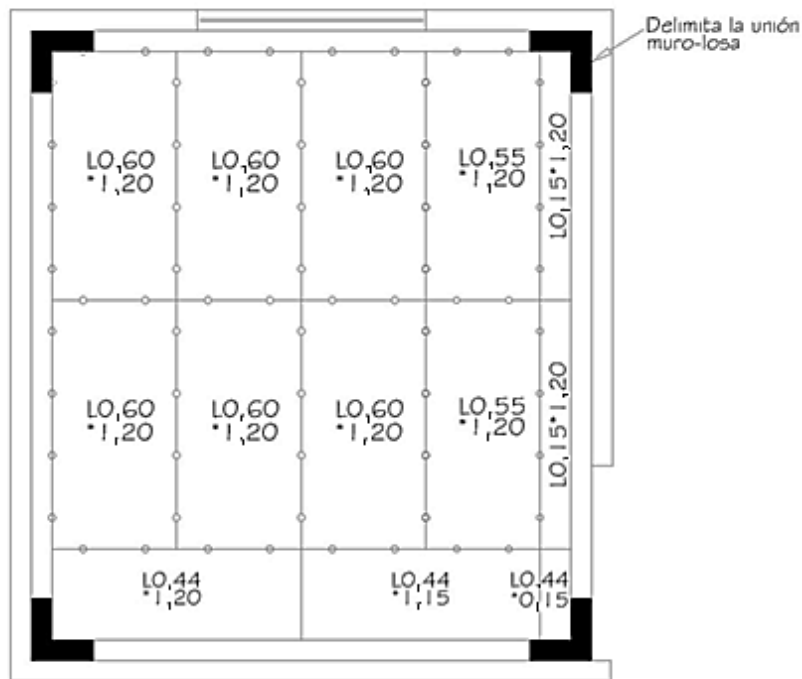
Planta de modulación de paneles en muros del dormitorio 2
